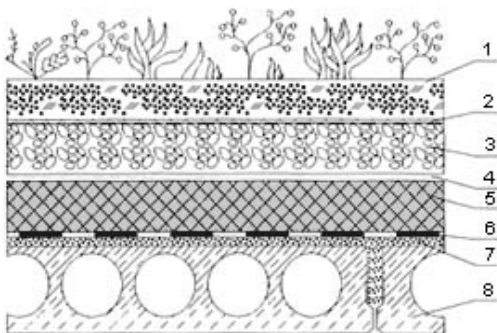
Приклад влаштування інверсійної експлуатованої покрівлі: 1 – рослинний шар; 2 – протикореневий шар; 3 – дренажний шар із гравію; 4 – фільтруючий шар; 5 – теплоізоляція; 6 – гідроізоляція; 7 – цементно-піщана стяжка; 8 – залізобетонна плита перекриття
